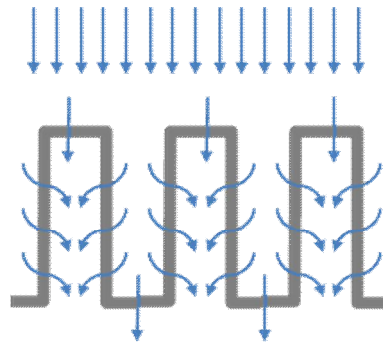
Vista en planta de un vertedero de laberinto tipo rectangular.
